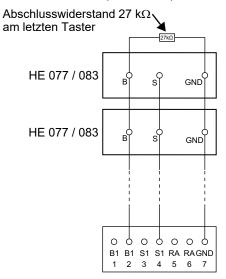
Anschlussplan Handansteuereinrichtung HE 077/HE 083 (Stair Panel)
